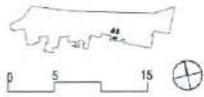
Plani i nëntokës të Hotelit me 3
